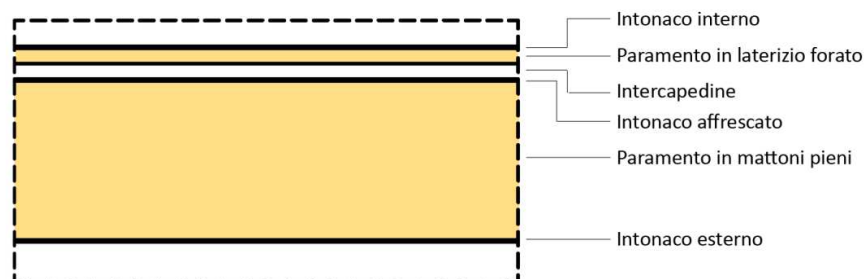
Pianta piano secondo. Risultati delle indagini stratigrafiche.
